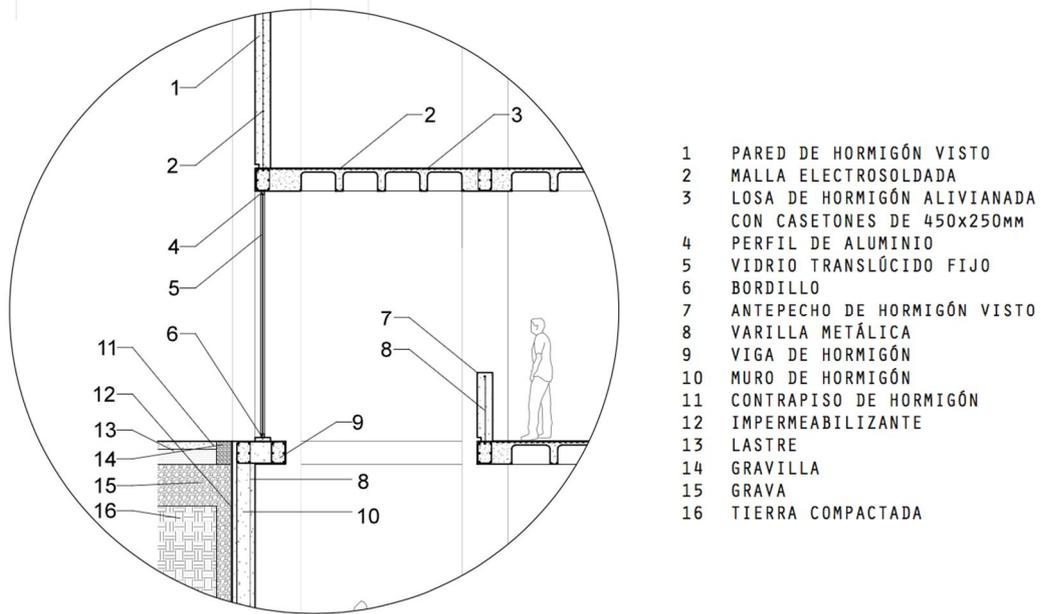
Detalle fachada norte plataforma. Elaboración propia
